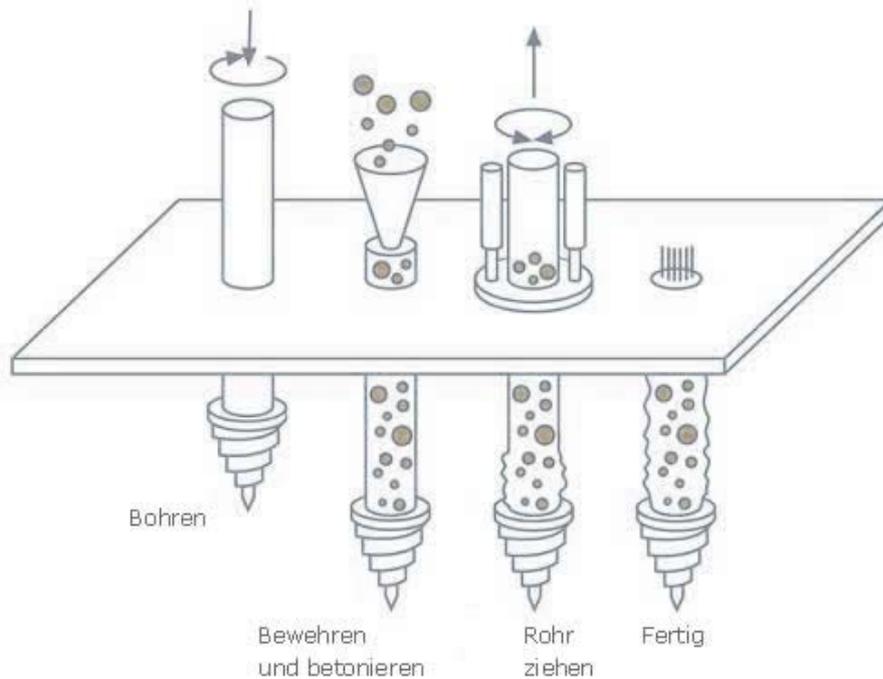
Ortbeton-Vollverdrängerbohrpfahlgründung System „FUNDEX“
